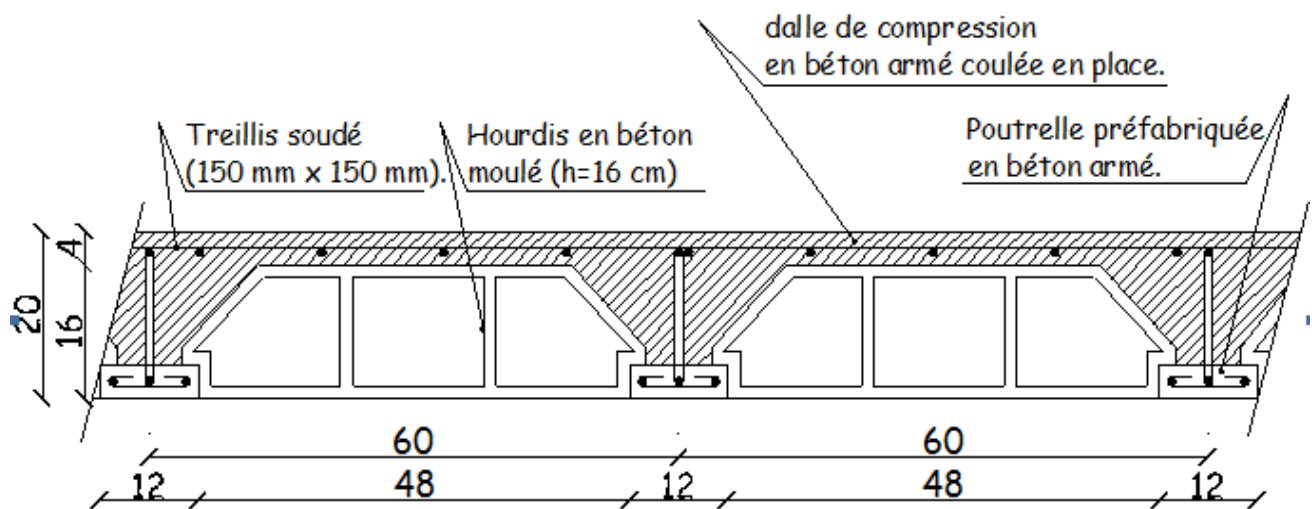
Plancher en béton armé avec poutrelles et hourdis
